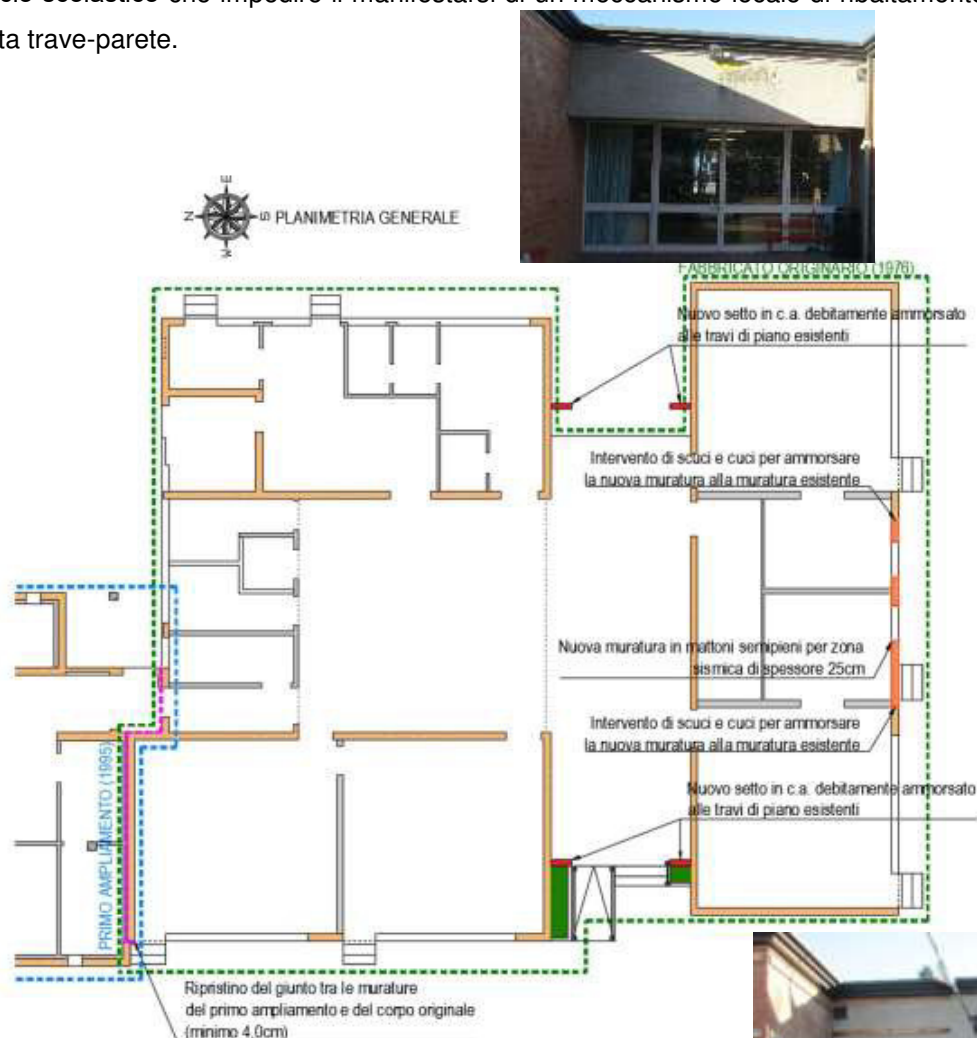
Pianta fabbricato originario con descrizione interventi previsti in progetto
